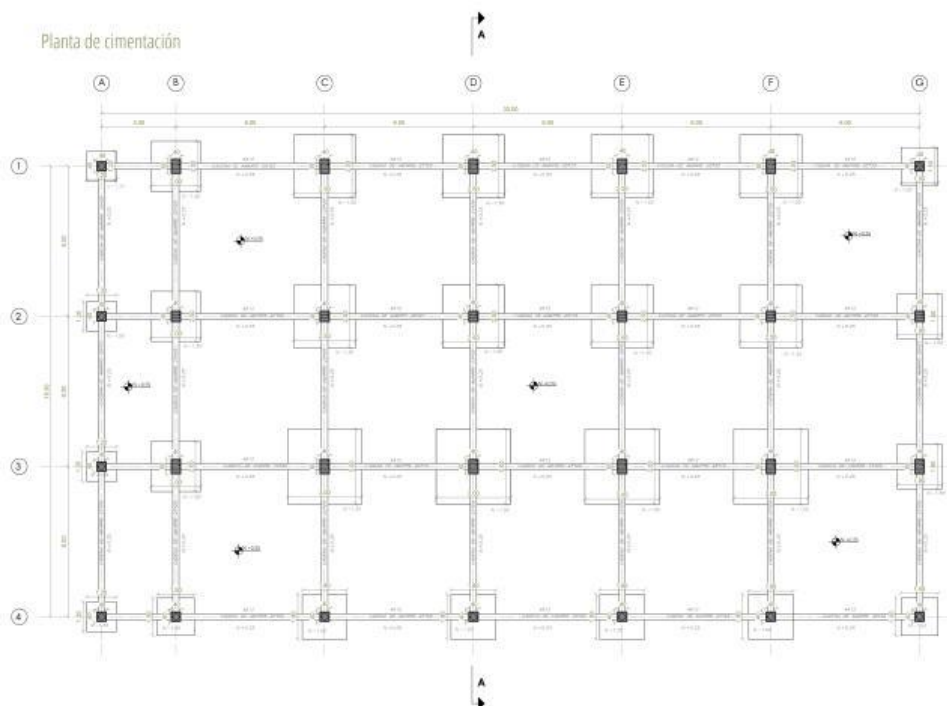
Cimentación bloque 1. Fuente: ilustraciones propias
